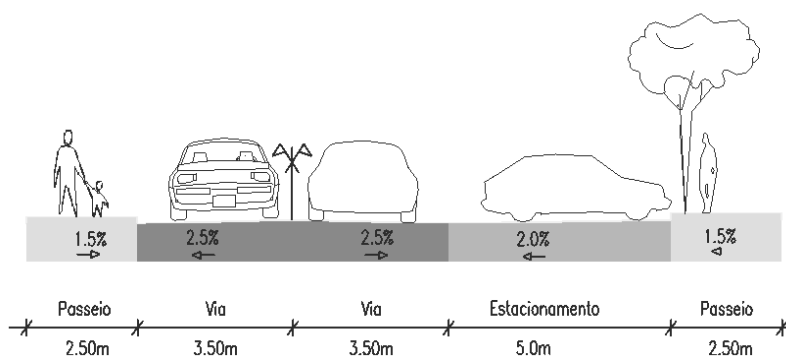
Perfil Transversal Tipo 2 – Eixos 4
